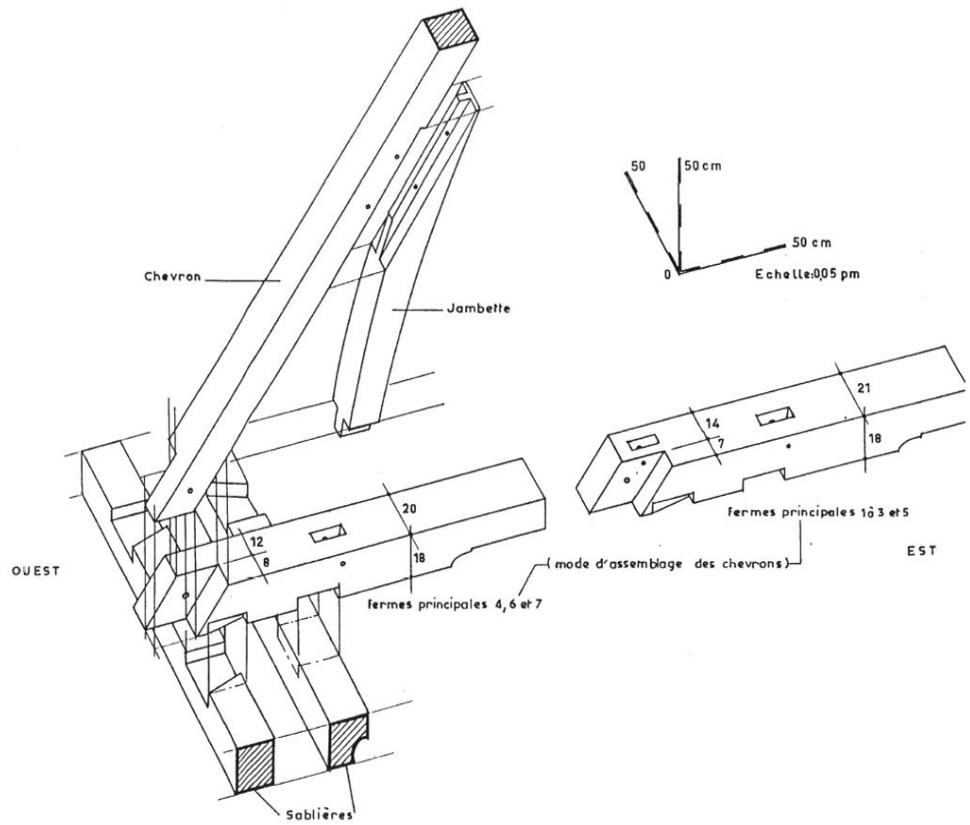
Charpente- Extrémité des entrails de la première campagne.
